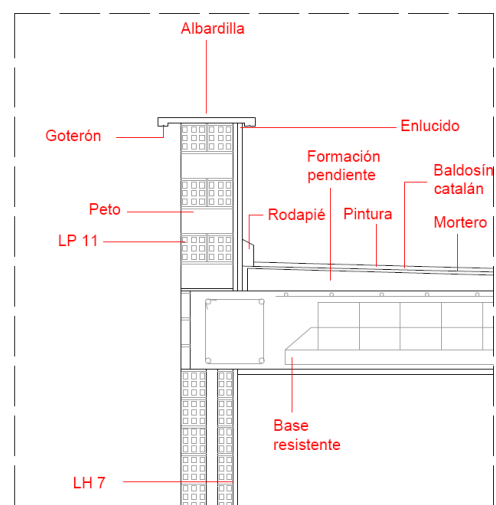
Detalle Cubierta [Anexo II Planos]
